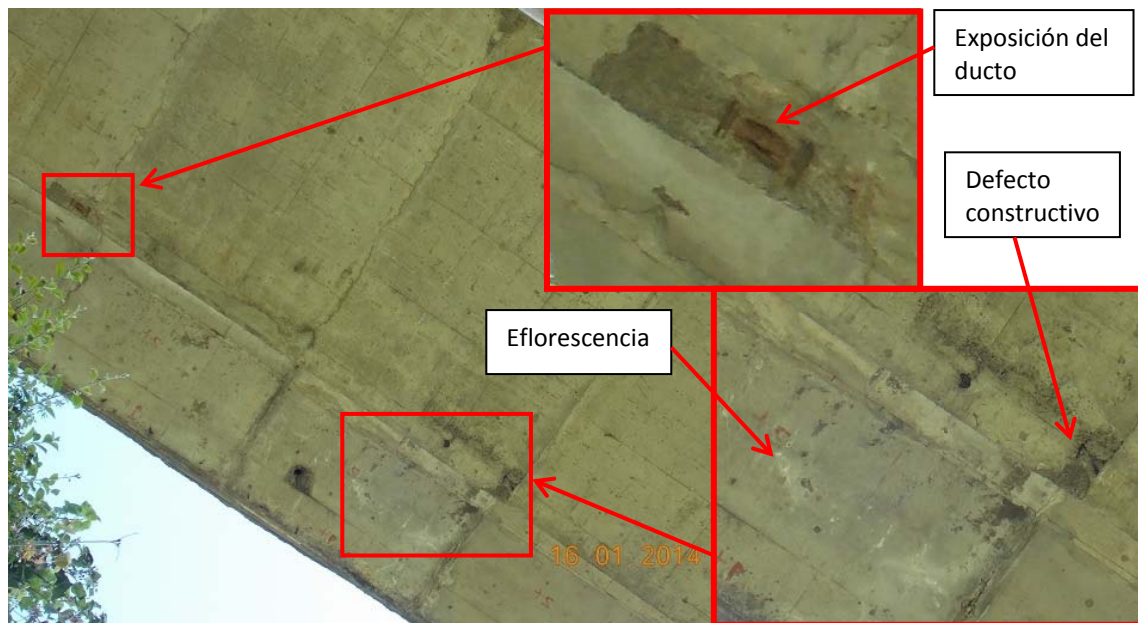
Defecto por colocación de encofrado, exposición del ducto de postensión y eflorescencia en viga cajón, tramo 2.
